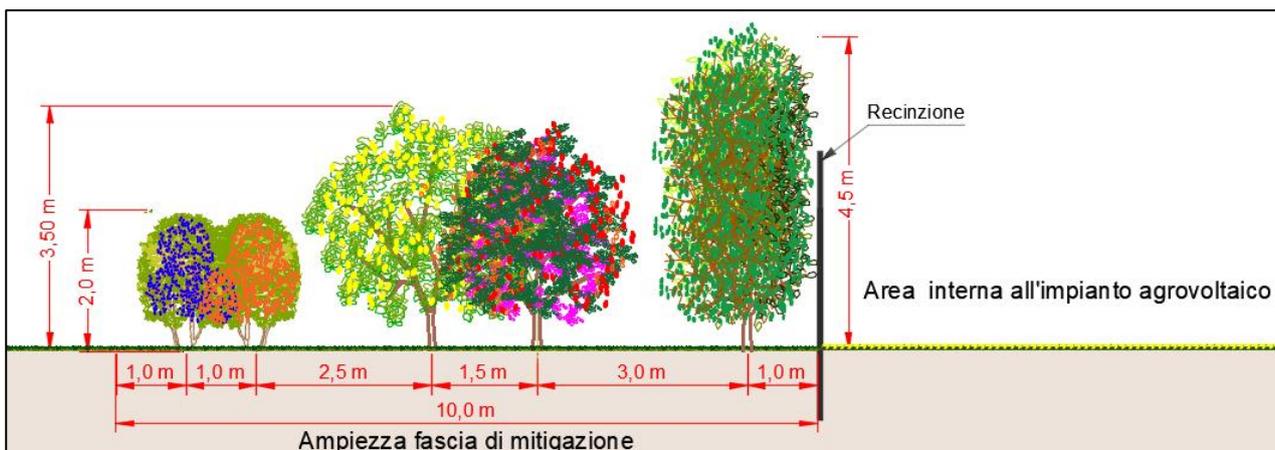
Rappresentazione della fascia perimetrale di mitigazione visiva: Area della biodiversità - vista in sezione
